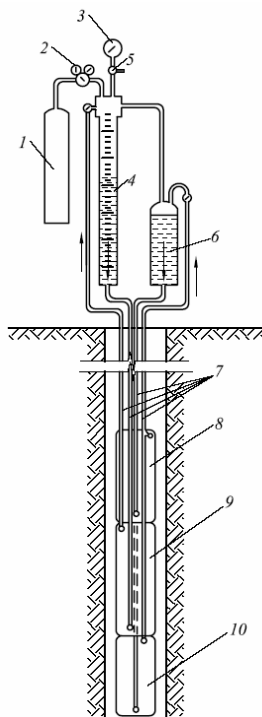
Схема прессиометра: 1 — газовый баллон; 2 — редуктор; 3 — манометр; 4 — измерительный цилиндр; 5 — кран-тройник; 6 — бачок; 7 — шланги; 8, 10 — вспомогательные камеры; 9 — рабочая камера
